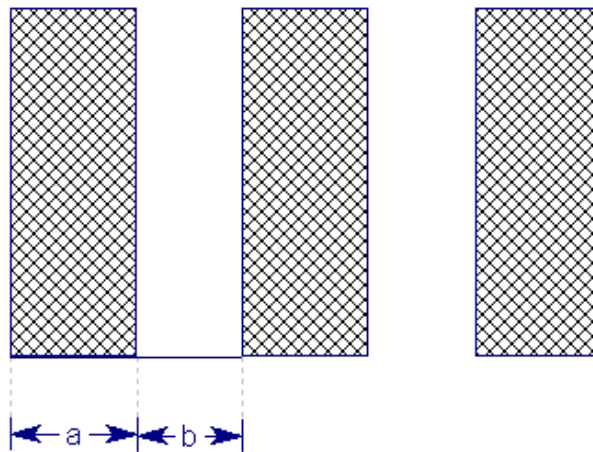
Vista en planta de la distribución de cintas de refuerzo.
